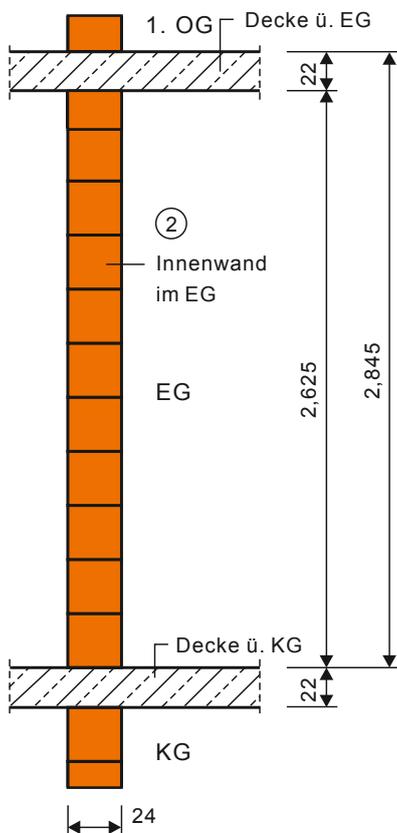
Schnitt durch die tragende Innenwand im Erdgeschoss
